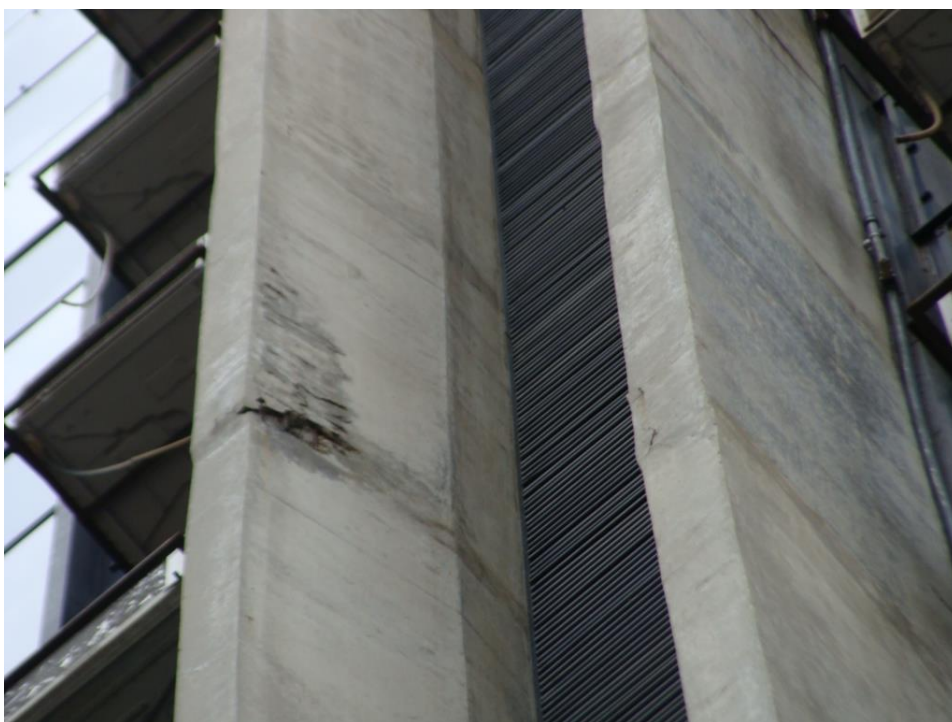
Armadura exposta pilar P13 (6º pavimento) (02/03/2021)
